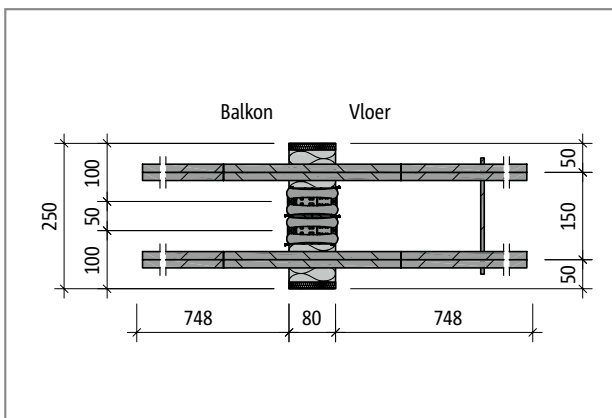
Schöck Isokorb® type Q-E-W-VV5: Bovenaanzicht
